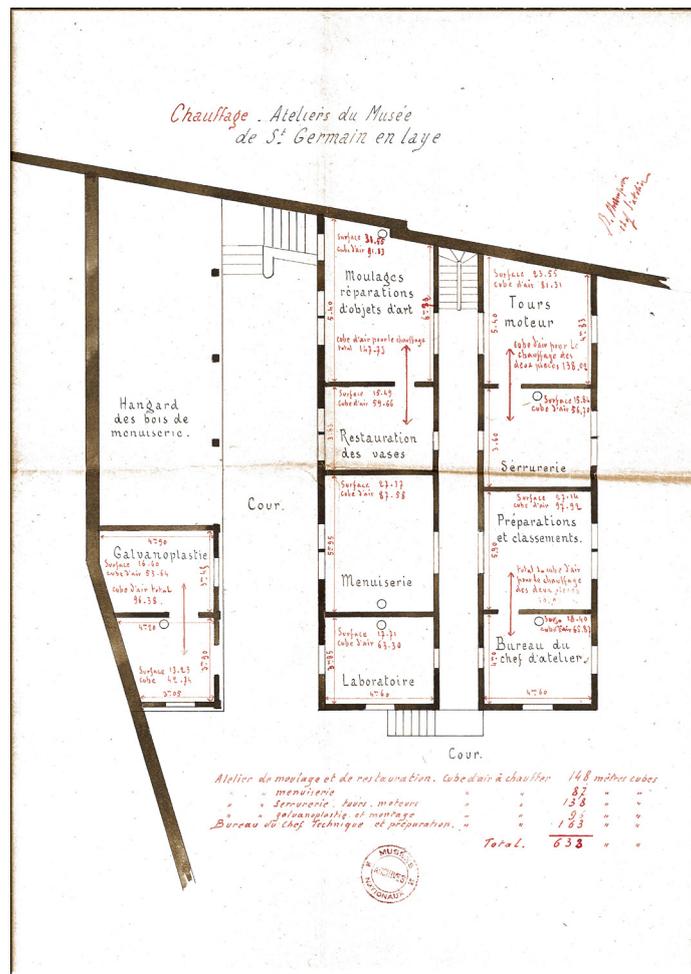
Plan des ateliers rue Thiers, AN 20144782/48, 3 février 1919
